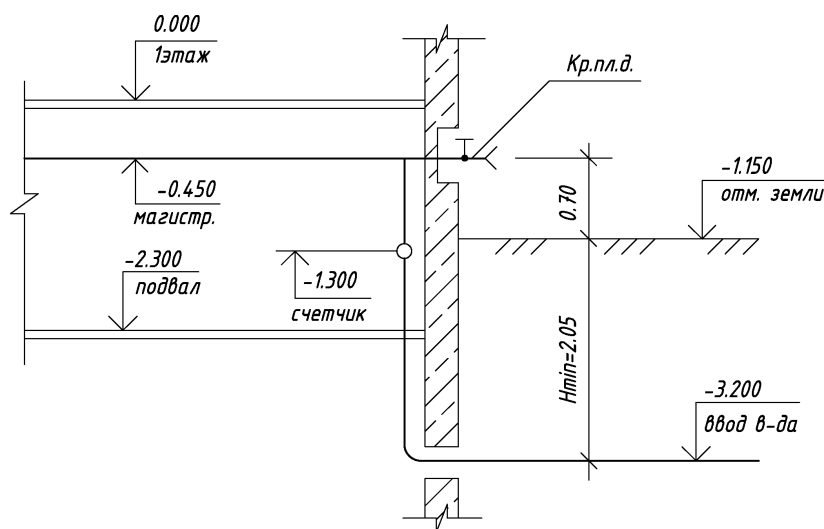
Схема к определению отметок трубопроводов на вводе
